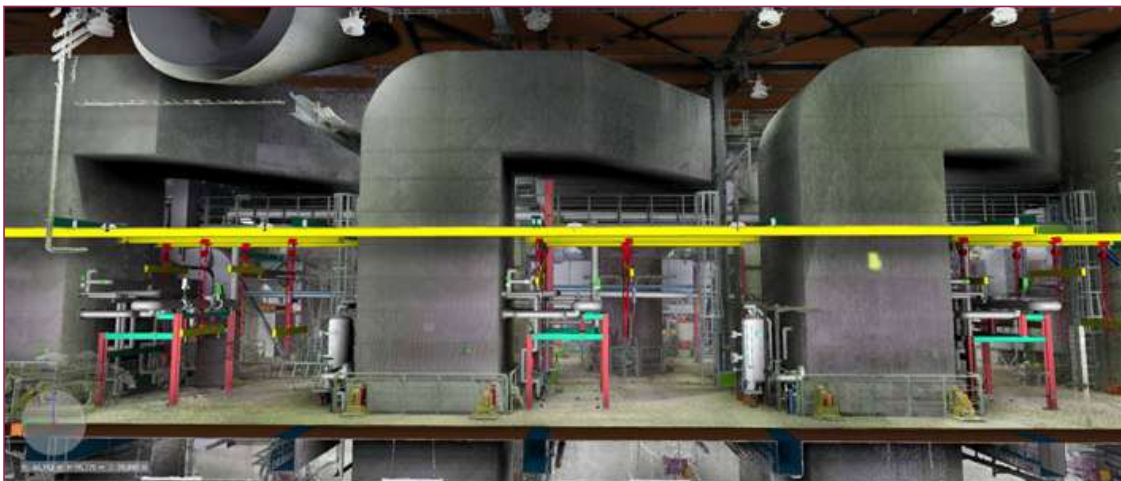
Anlagenscan mit 3D-Modell – neu geplante Komponenten
